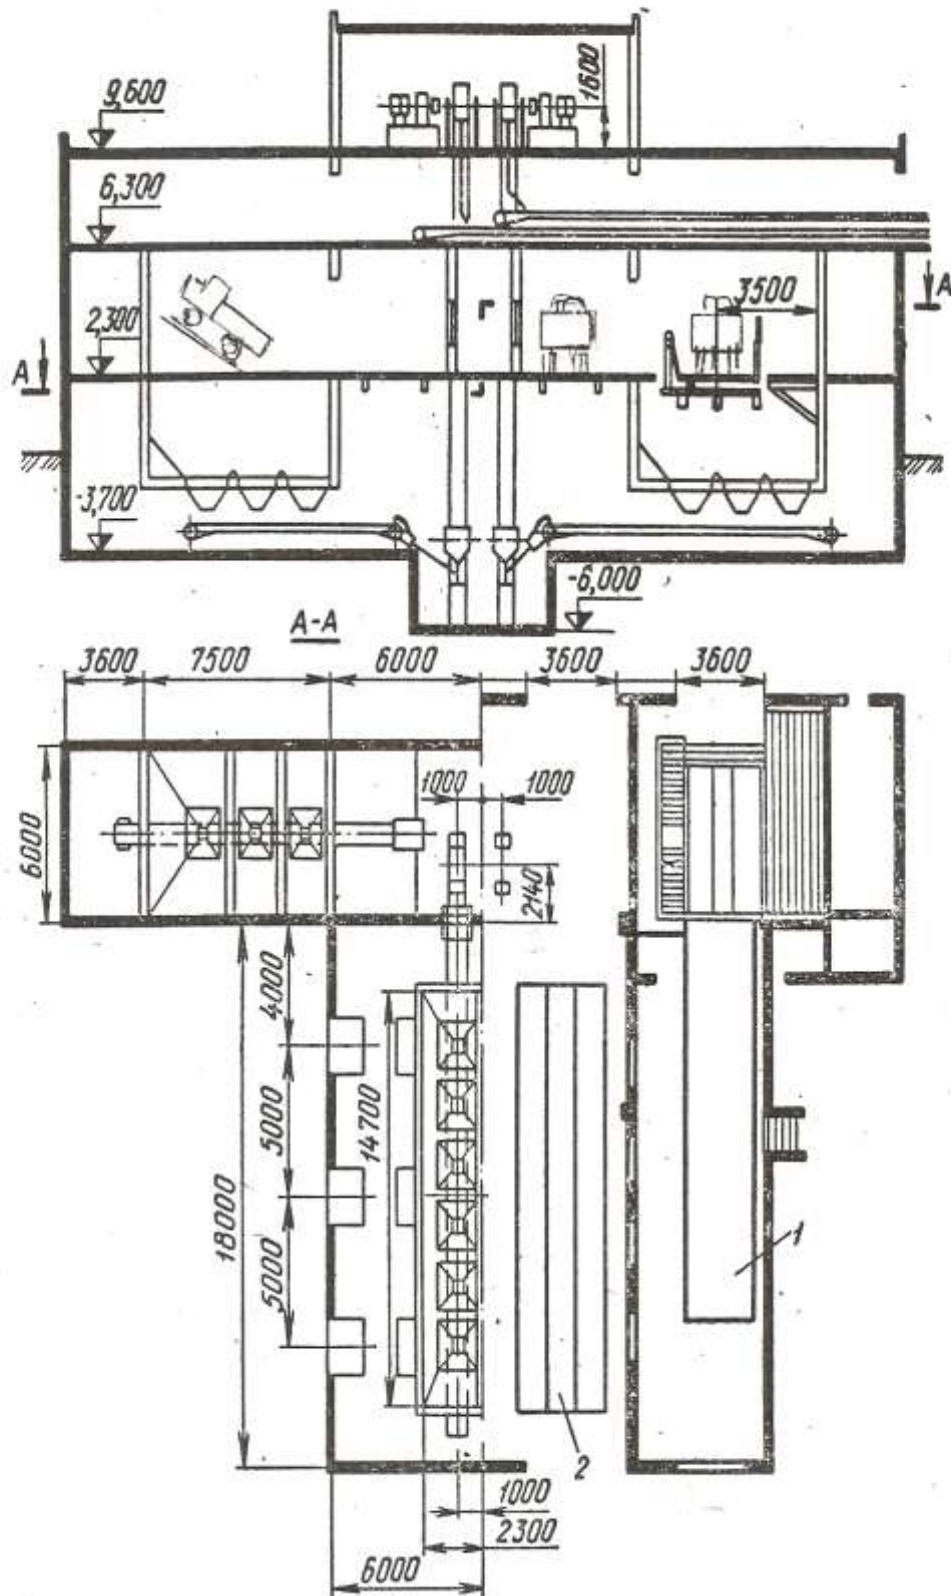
План і розріз ділянки розвантаження автовантажівок
